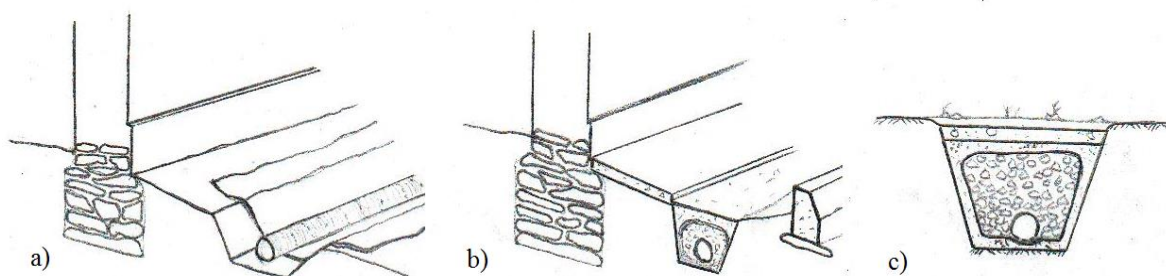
a) Abertura de vala para aplicação de manta geotêxtil e tubo de drenagem, b) Pormenor construtivo da solução de drenagem de águas, c) Pormenor construtivo em corte do sistema de drenagem das águas, (Fonte: de autor)
